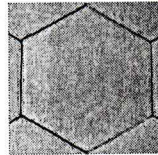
"Blokret", ou lajota sextavada em concreto pré-moldado. – Fck 35 Mpa.
